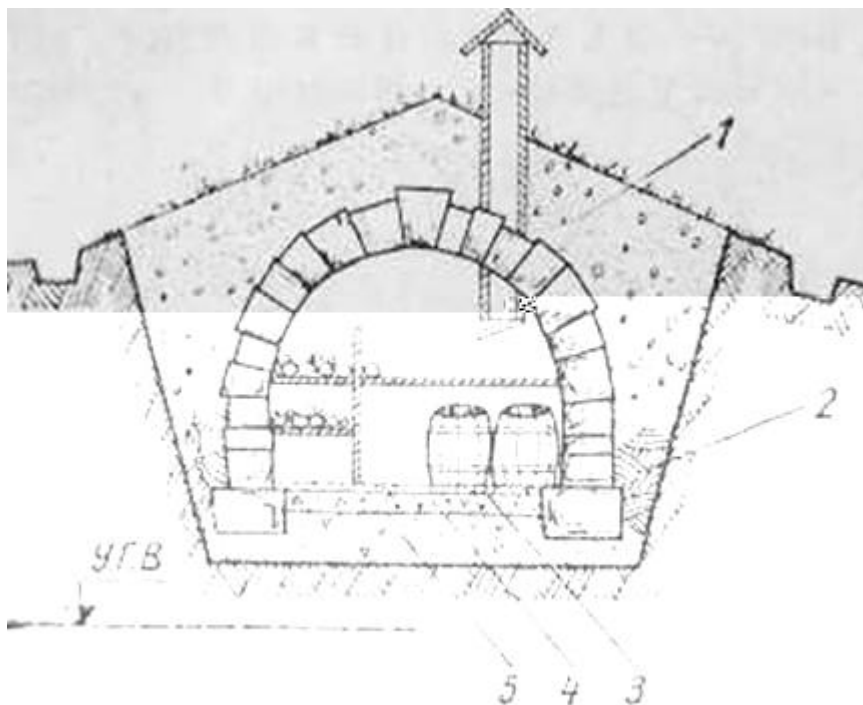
Каменный погреб, сооруженный при низком уровне грунтовых вод: 1 – засыпка грунтом; 2 – глиняный замок; 3 – цементная стяжка; 4 – бетон; 5 – щебень
